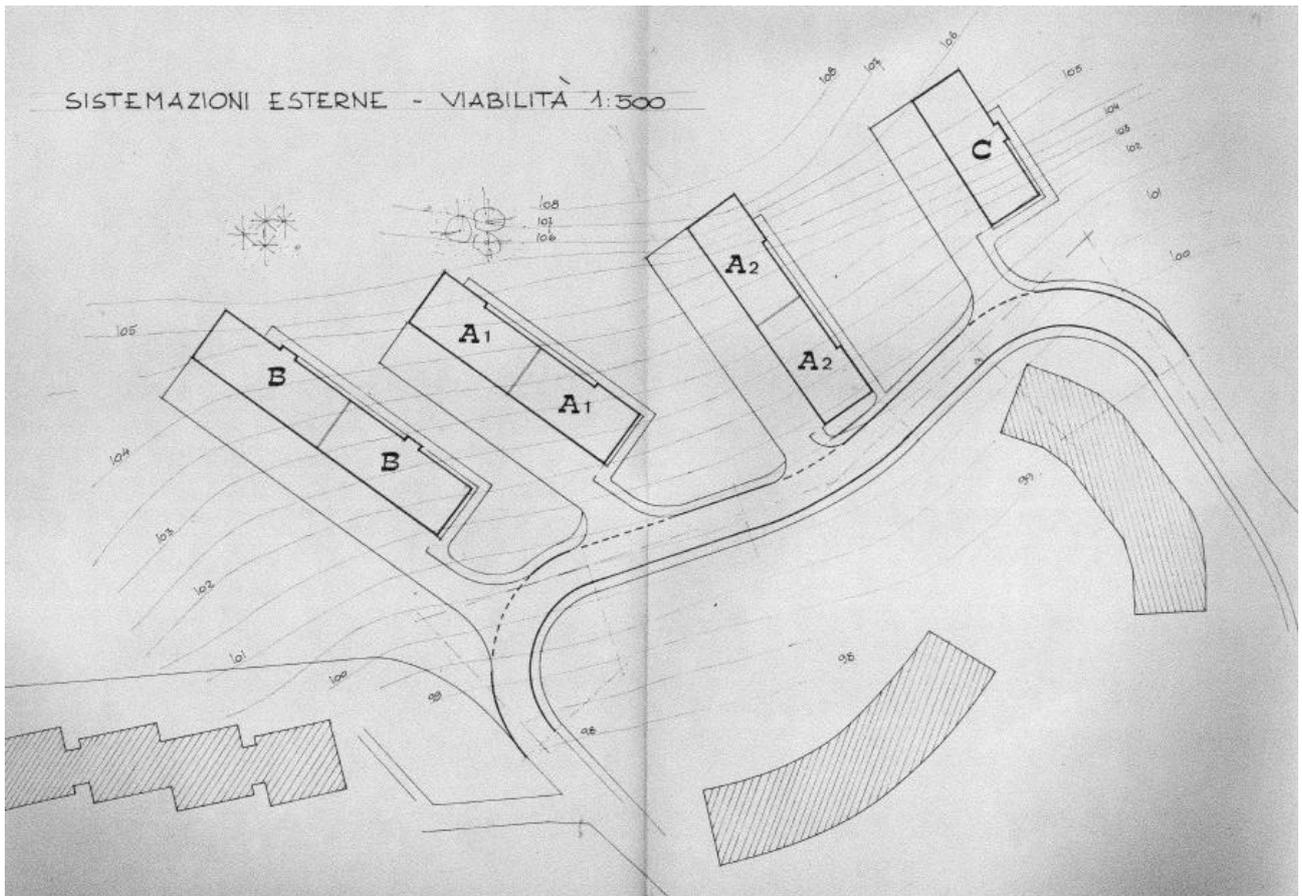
Individuazione dei fabbricati su planimetria di progetto, in giallo il/i fabbricato/i oggetto del servizio
